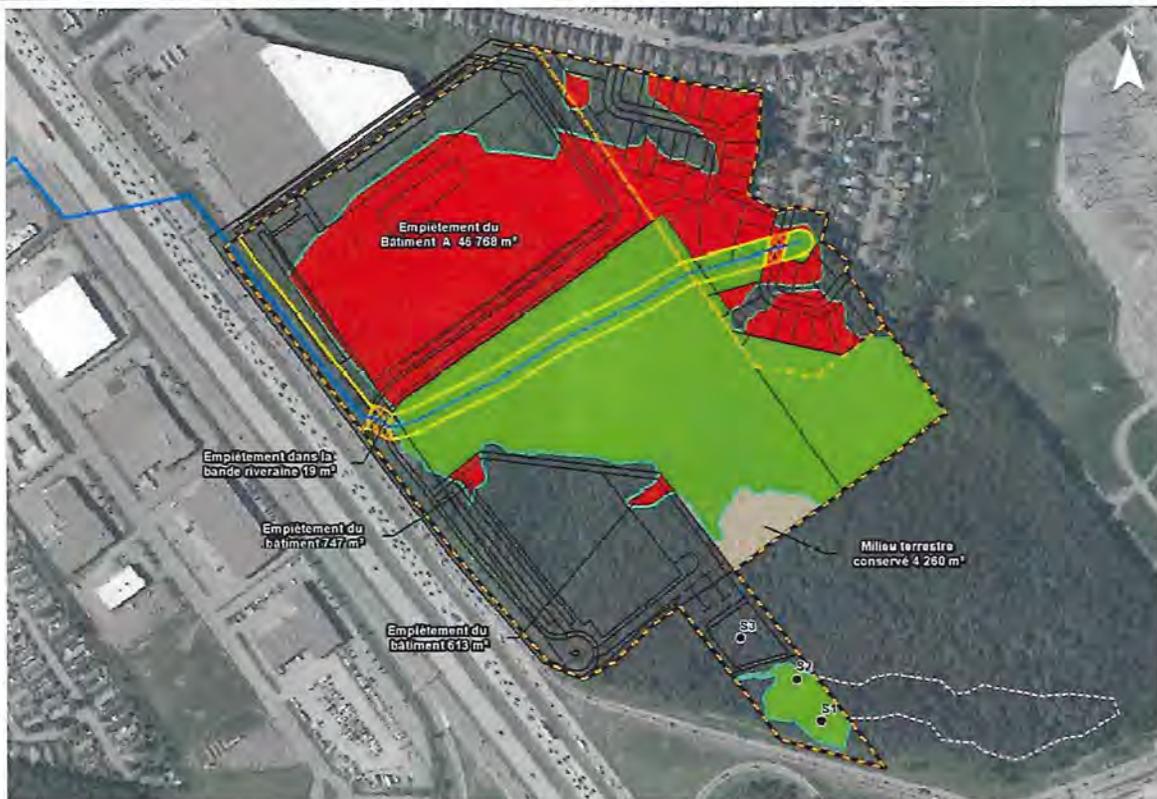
Plan de développement final, soumis le 17 juin 2021. ( 23-24, 2021)
